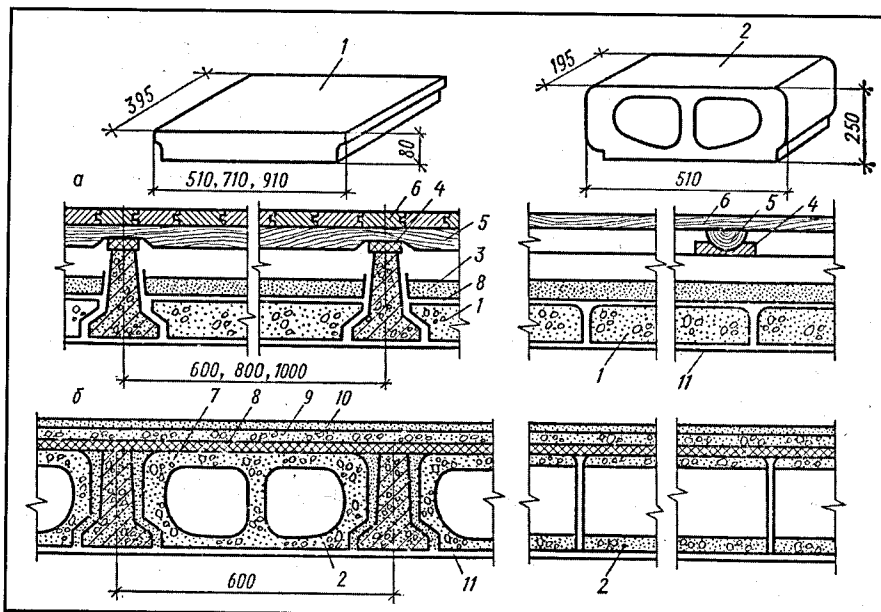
Міжповерхові перекриття по збірних залізобетонних балках: а - з накатом із плит; б - з заповненням вкладишами; 1 - гіпсобебетонні плити; 2 - легкобебетонні вкладиші; 3 - шлак; 4 - звукоізоляційна прокладка; 5 - лага; 6 - дерев'яна підлога; 7 - оргаліт; 8 - толь; 9 - легкий бетон; 10 - чиста підлога (мінеральна); 11 - затирка.
